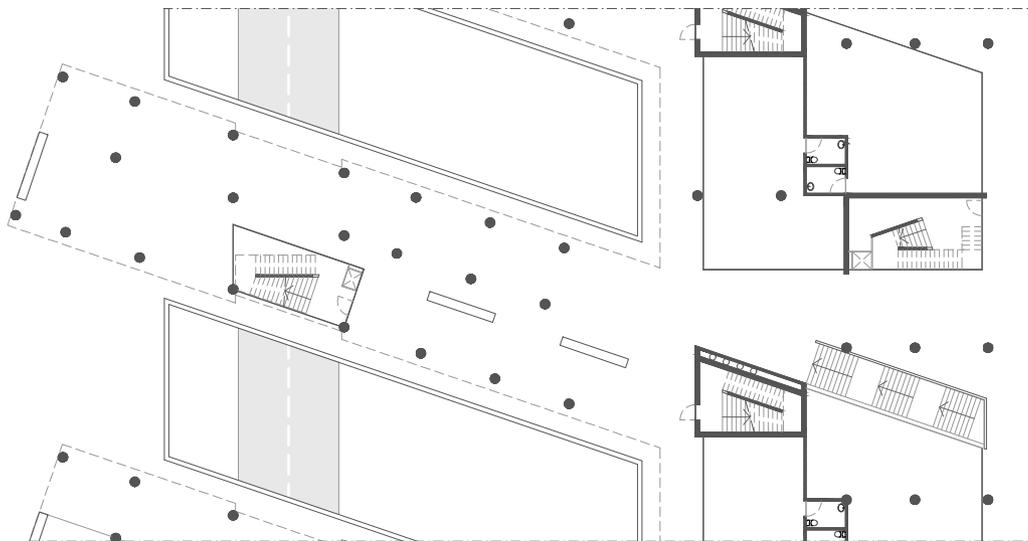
Planta piso do parque urbano (Fonte: Marco Andrade, 2019)
